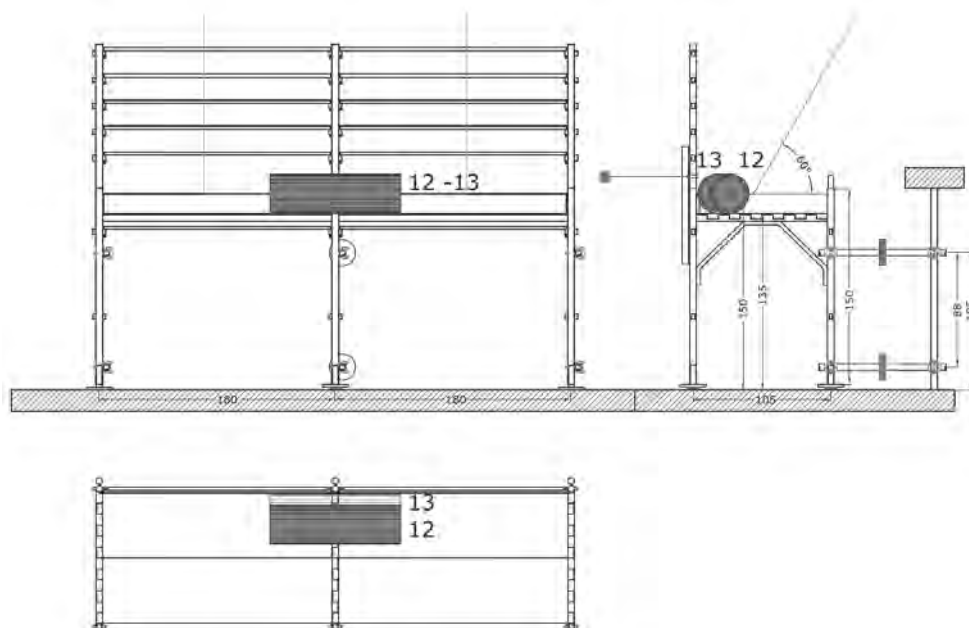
Prova d'impatto con rullo cilindrico su traverso - Schema CD
